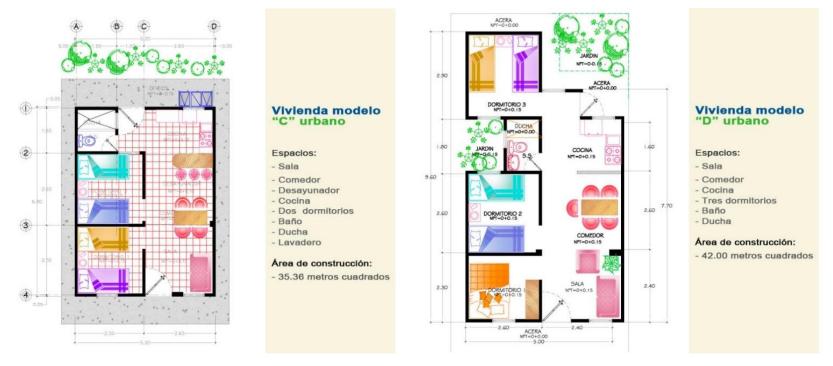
, Plantas Arquitectónicas tipo C y tipo D
